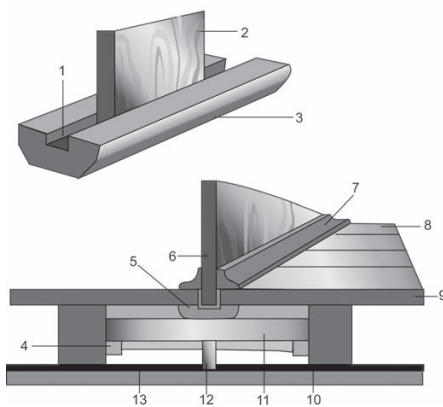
Перегородка располагается между балками и опирается на шпалу: 1 — паз; 2 — доска; 3, 5 — лаги; 4 — брусок; 6 — перегородка; 7 — плинтус; 8 — пол; 9 — балка; 10 — подшивка; 11 — шпала; 12 — диафрагма; 13 — толь
